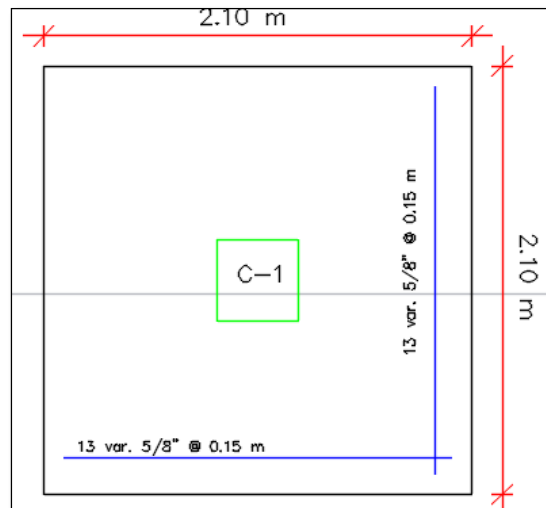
Vista en planta de zapata aislada para columnas céntricas.
